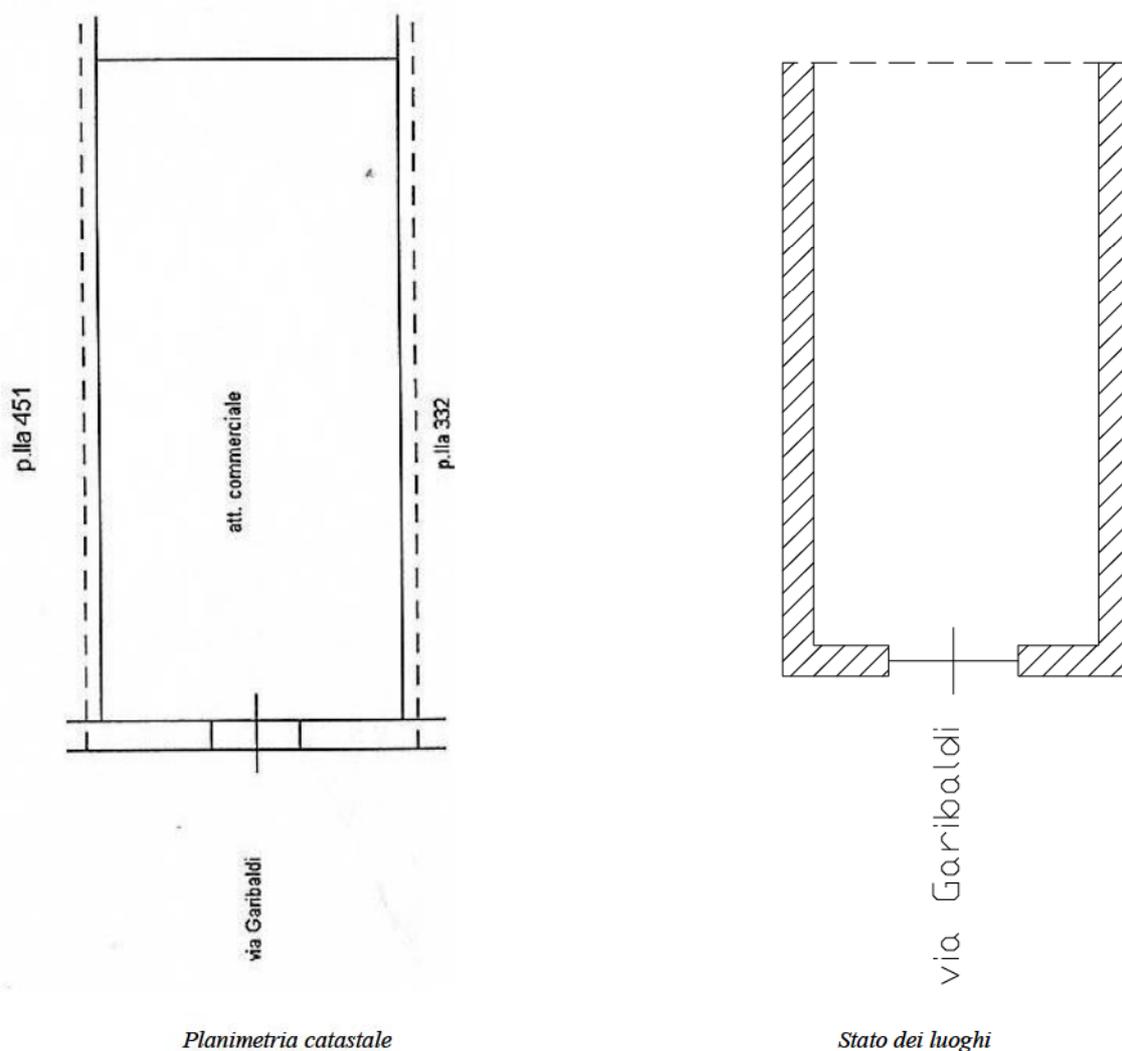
Confronto tra planimetria catastale e stato dei luoghi (subalterno 7)
